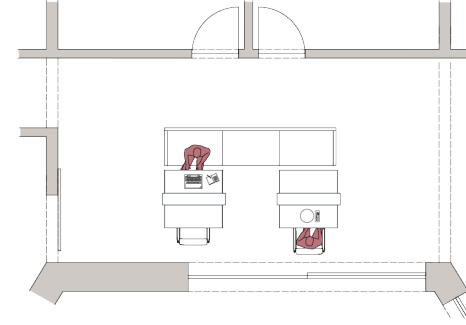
Grundrissvariante 1 - Individuell
